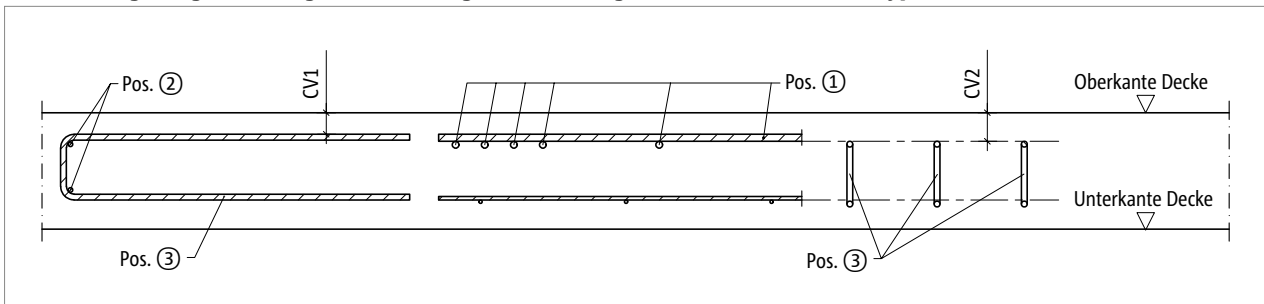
Schöck Isokorb® XT Typ CL: Bauseitige Bewehrung Außenecke (Schnitt XT Typ CL-L-CV1, Ansicht XT Typ CL-R-CV2)
